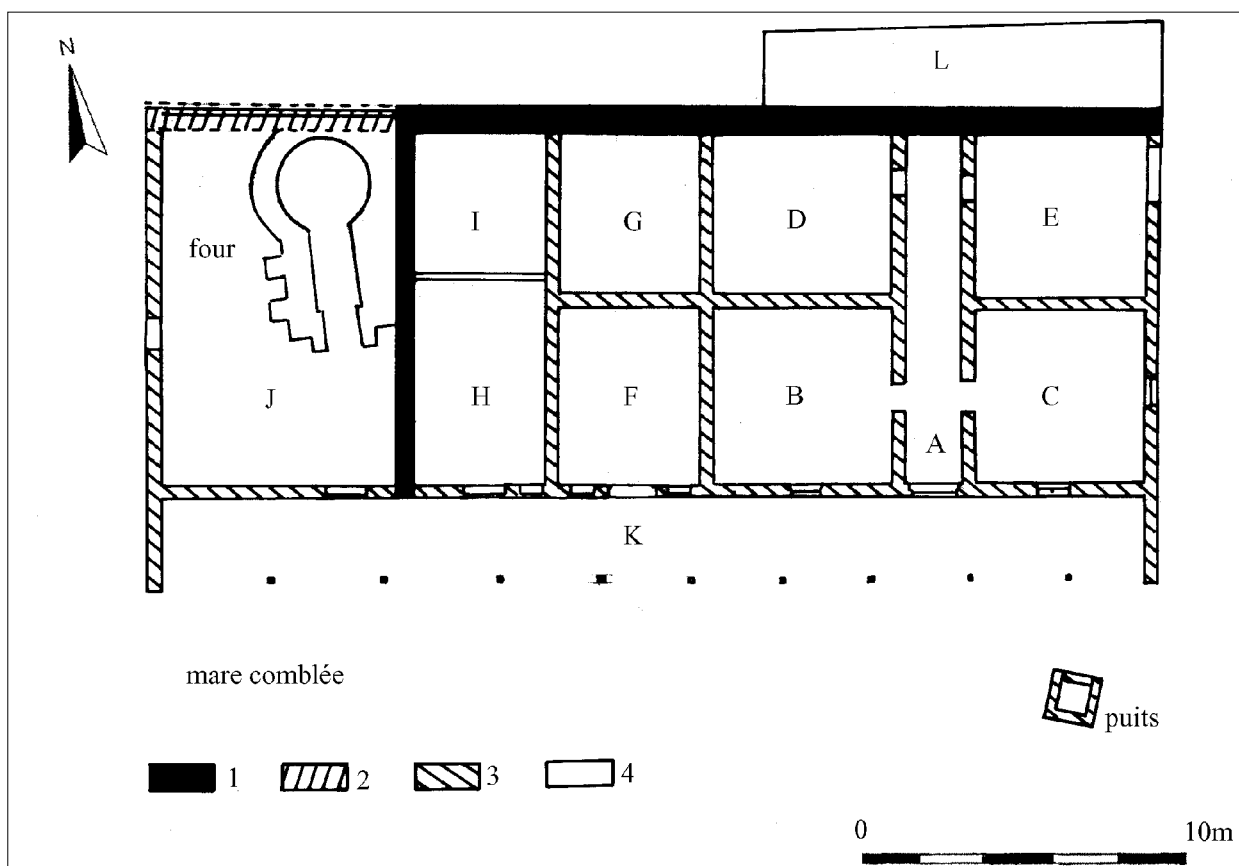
COX. ATELIER LAFFONT. PLAN AU SOL. *Relevé Jean Carvaillo et Olivier Stoker.
